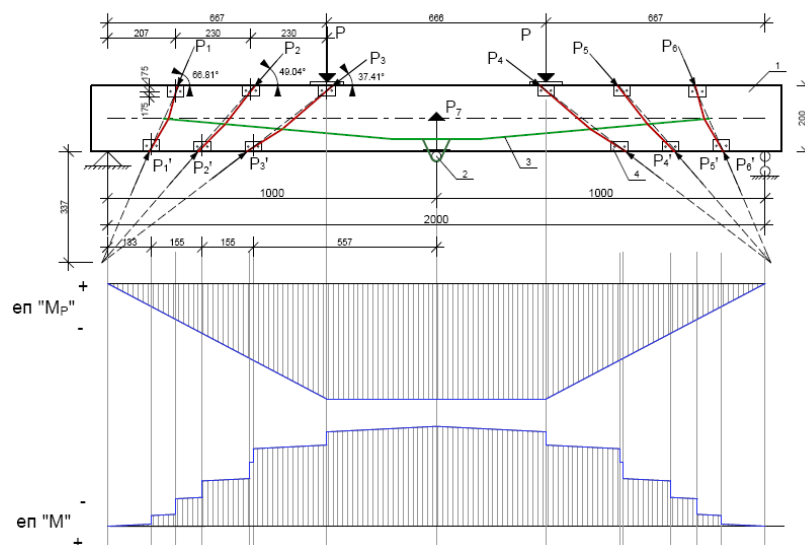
Регульовано напружена залізобетонна балка (варіант №2): 1 – залізобетонна балка; 2 – коток; 3 – напружена арматура; 4 – закладні деталі у вигляді пластин
